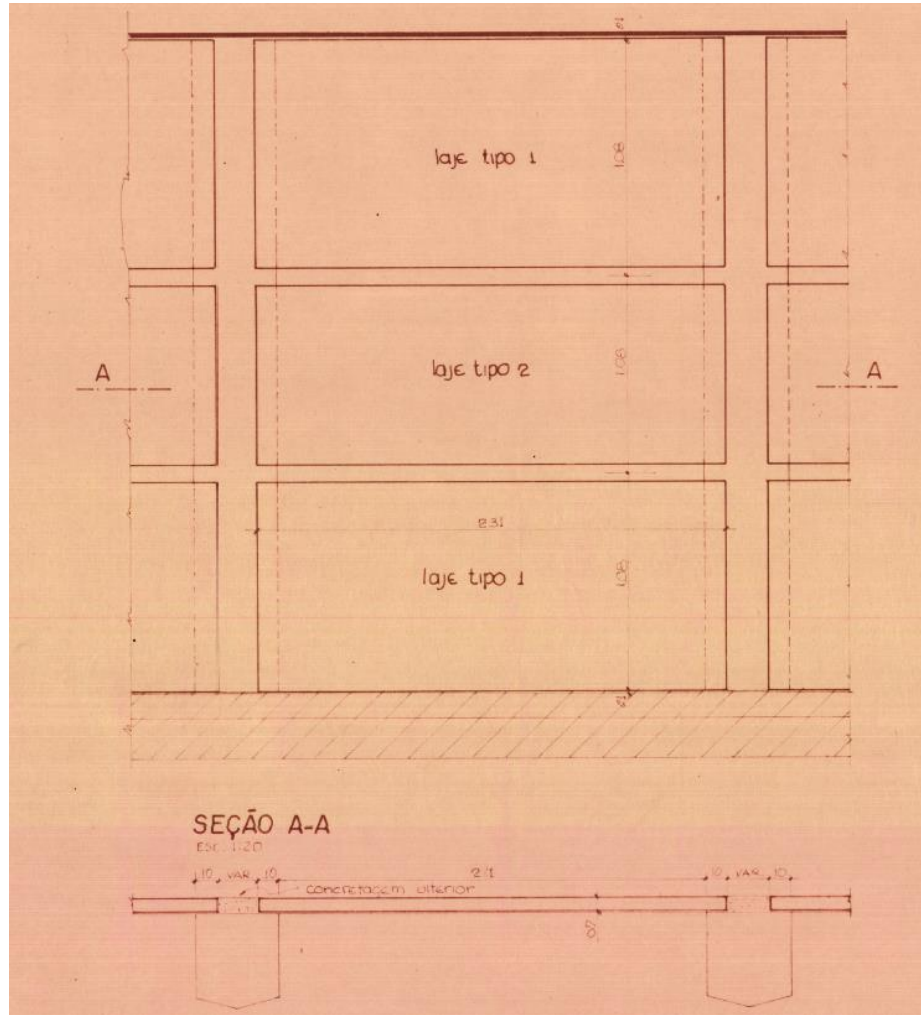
Vista superior e transversal das placas (lajes) de concreto simplesmente apoiadas nas vigas engastadas
